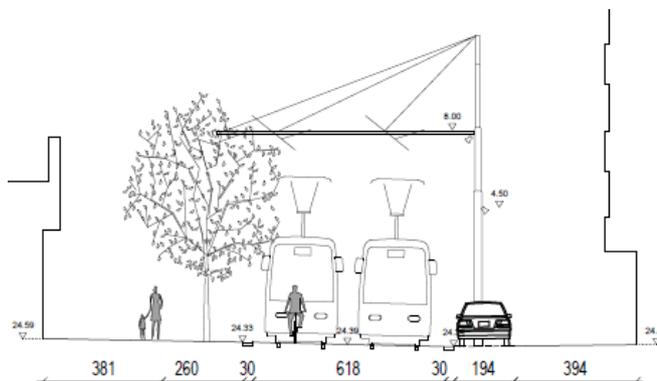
Coupe au niveau de la chaussée de Neerstalle (A-Practice, 2021)
